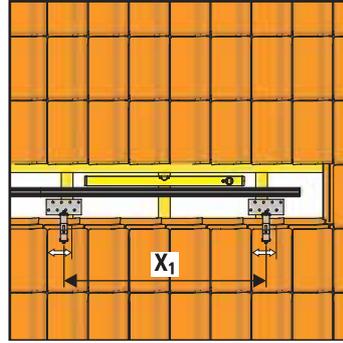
Determinazione della posizione di montaggio dei ganci da tetto
